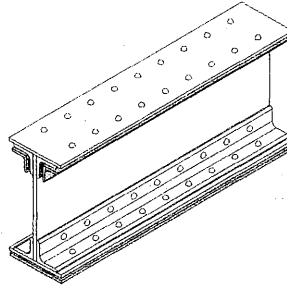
9. Refuerzos metálicos de vigas: refuerzos de alas con chapas soldadas.
